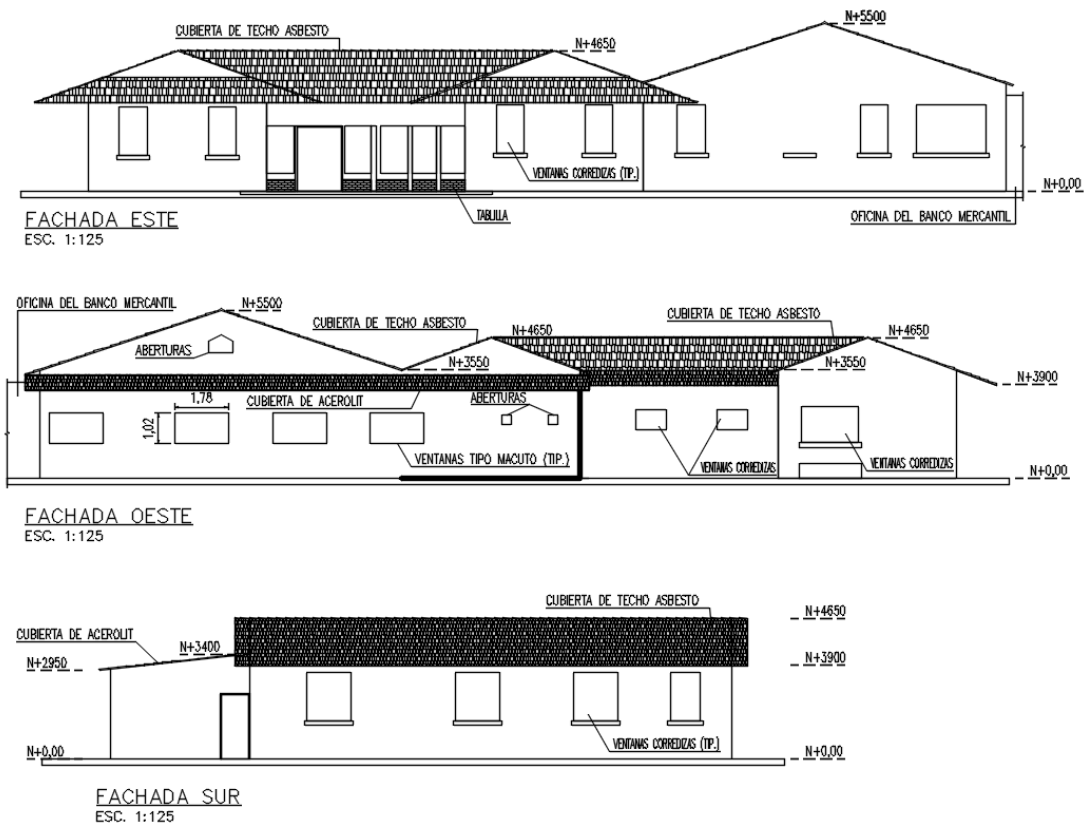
Levantamiento de las elevaciones en datum arbitrario, de las fachadas del ala izquierda del EN7. Fuente: Autor.
